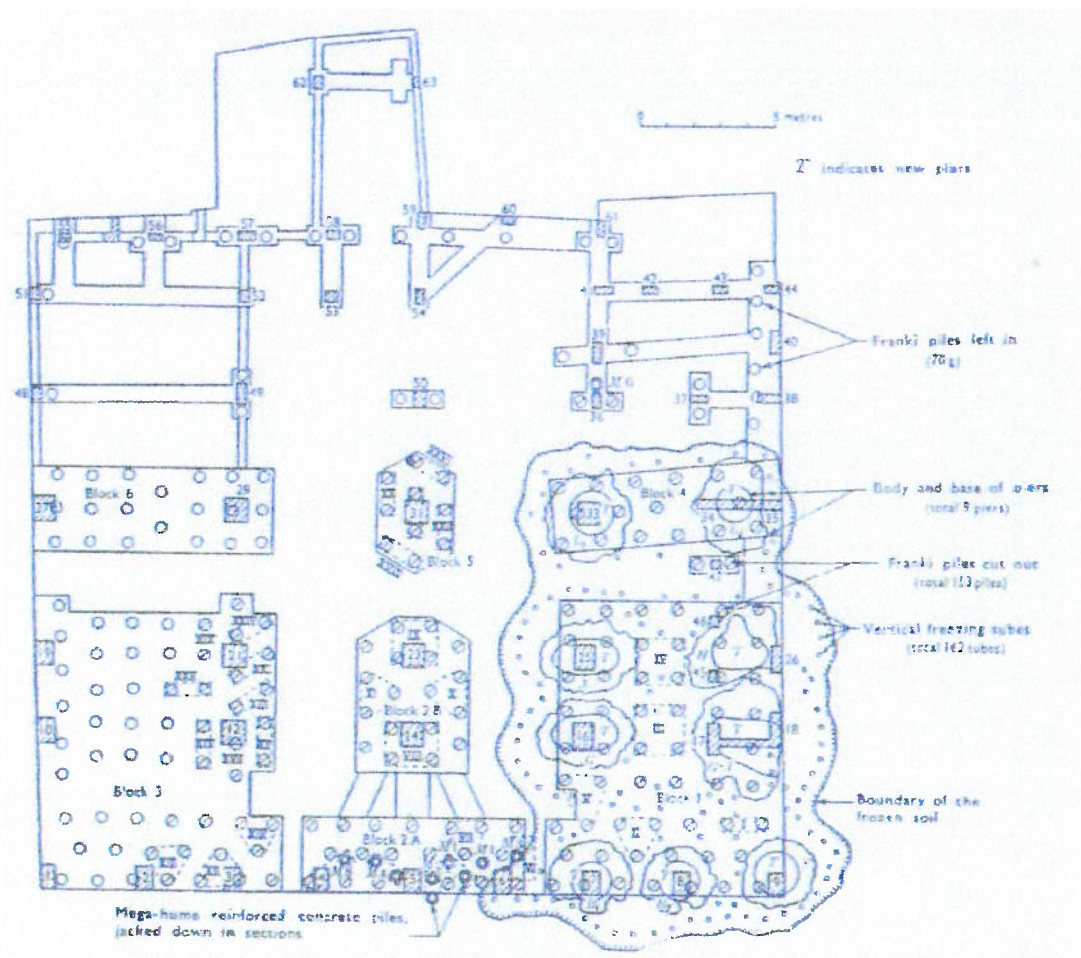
Detalhe da planta de locação das estacas de reforço.
